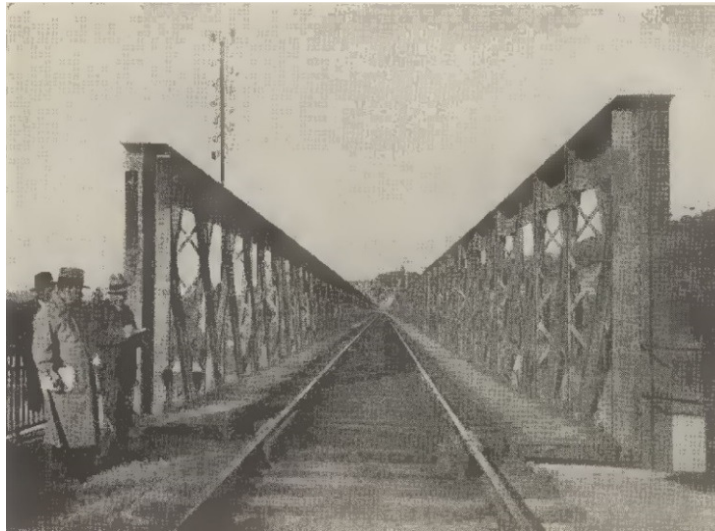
Vista da Ponte da Praia na sua inauguração [65]
